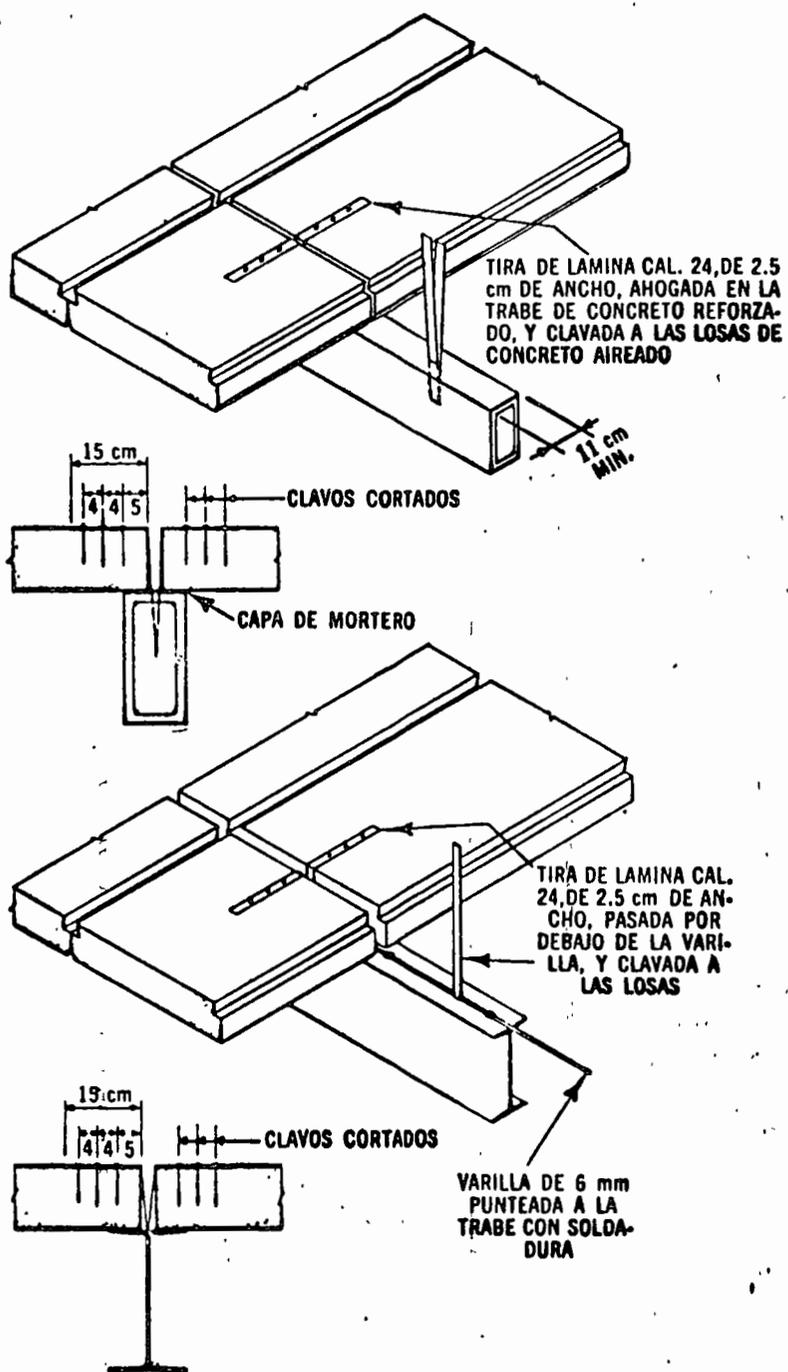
Fijación de las losas de concreto aireado a las vigas de soporte
